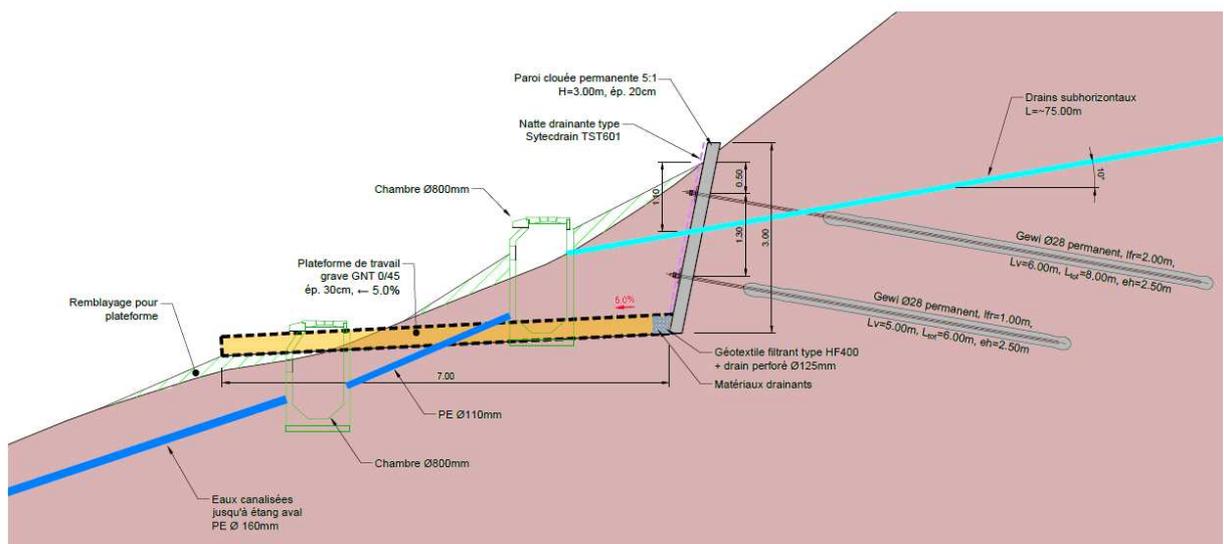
Plan et coupe-type des drains subhorizontaux (drainage du versant amont). Tiré de (1).
